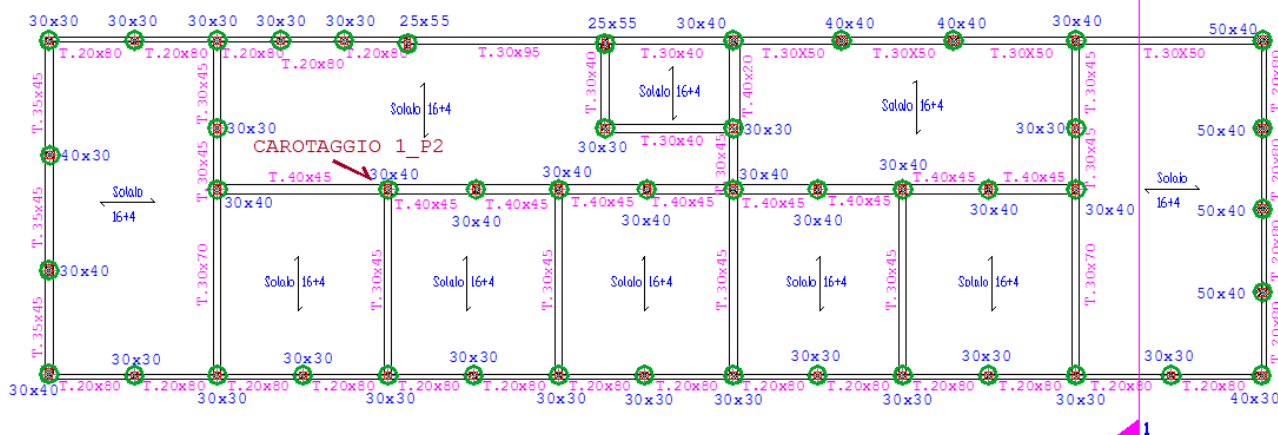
Localizzazione dei carotaggi al piano secondo
